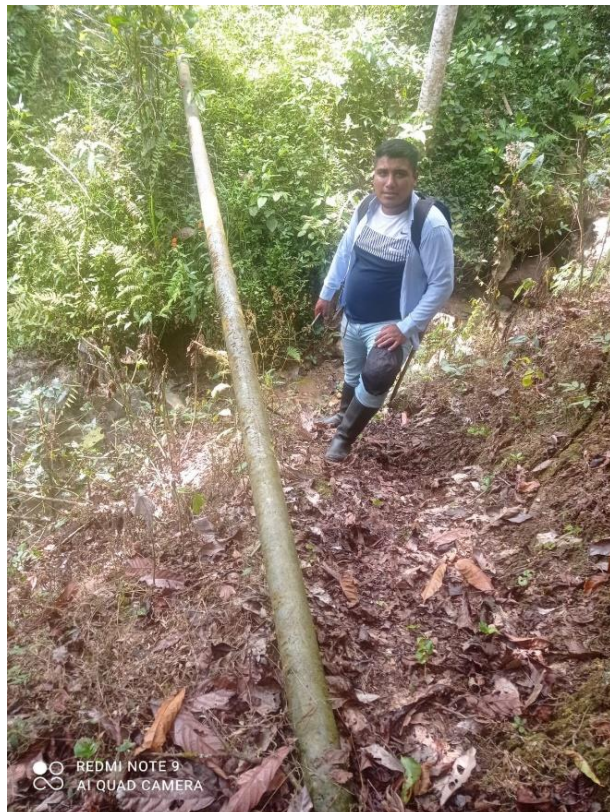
Cámara Rompe Presión Tipo 6 – 03
